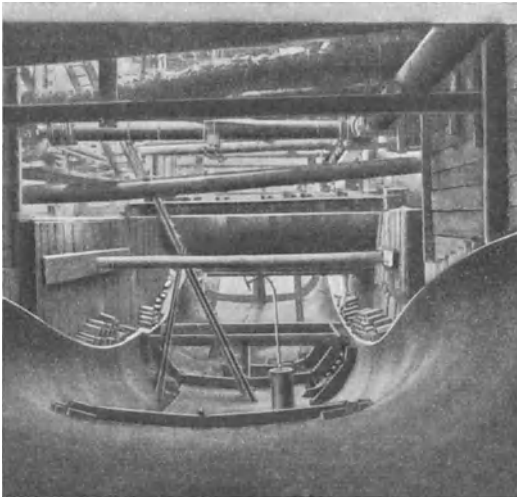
Kreuzungsbauwerk eines Notauslasses (nach Hahn und Langbein).
